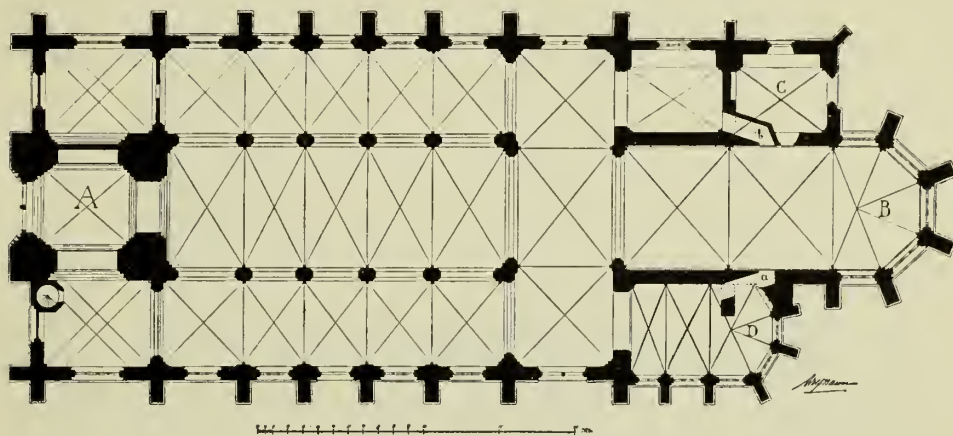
Duisburg. Grundriss der Salvatorkirche.
